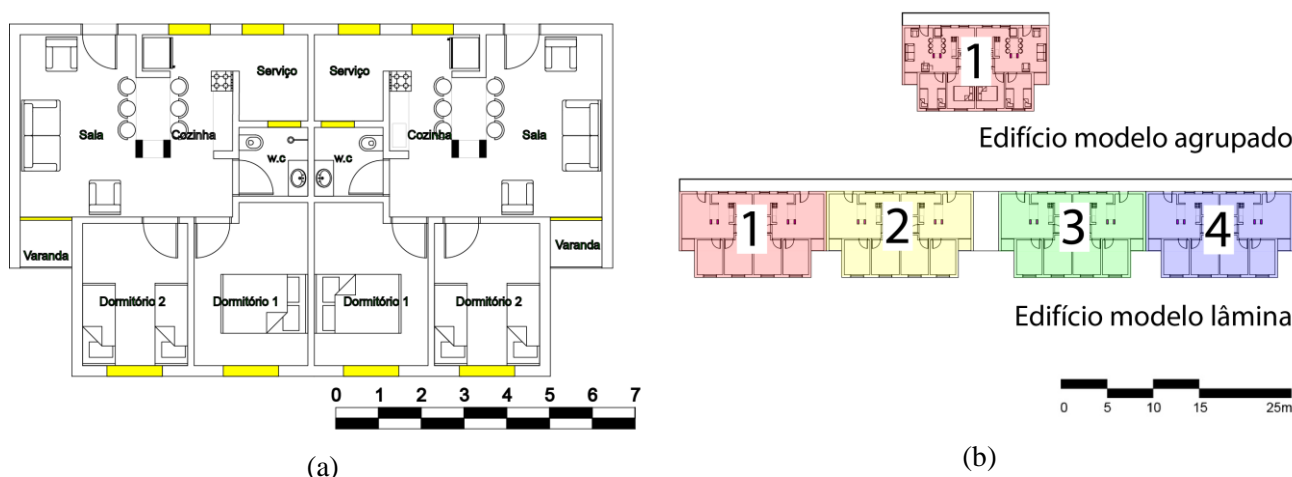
(a) Planta baixa com indicação de aberturas (cor amarela); (b) Planta esquemática dos modelos de edifícios lâmina e agrupado; Fonte: Acervo próprio.
